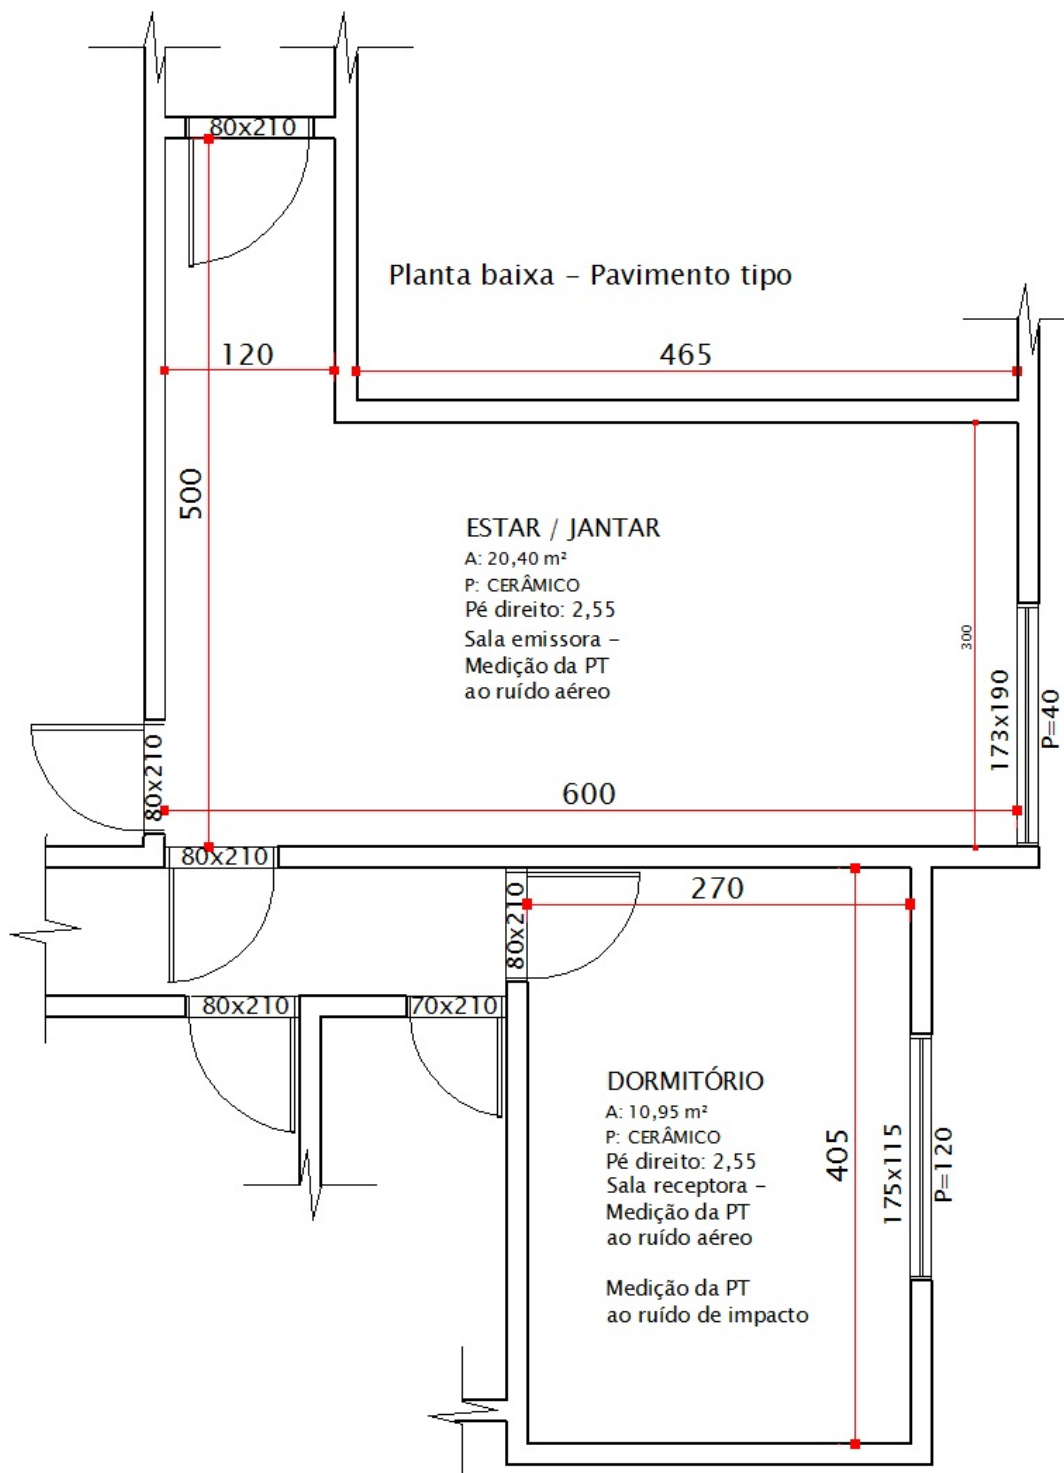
Planta baixa - pavimento tipo - 10-R8-N-BCE-PC
